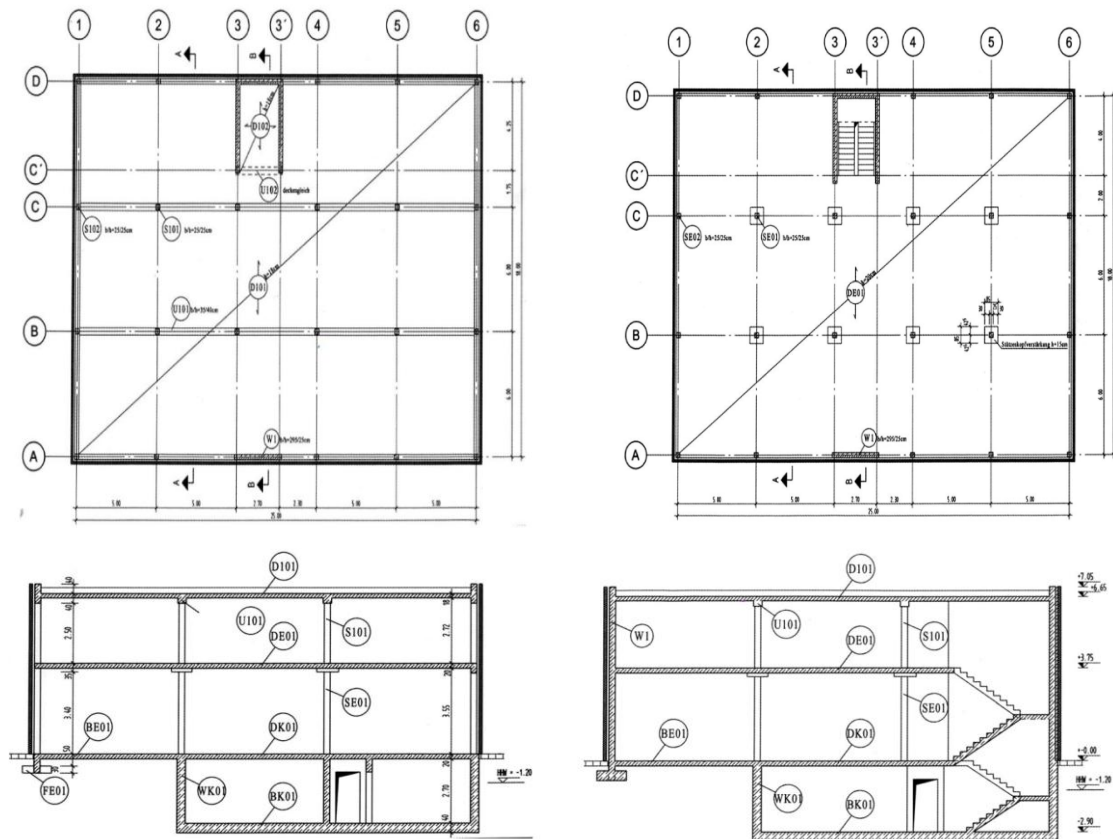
Positionspläne des Referenzgebäudes (links oben: Obergeschoss; rechts oben: Erdgeschoss; links unten: Schnitt A:A; rechts unten: Schnitt B:B) [Lohm04]
